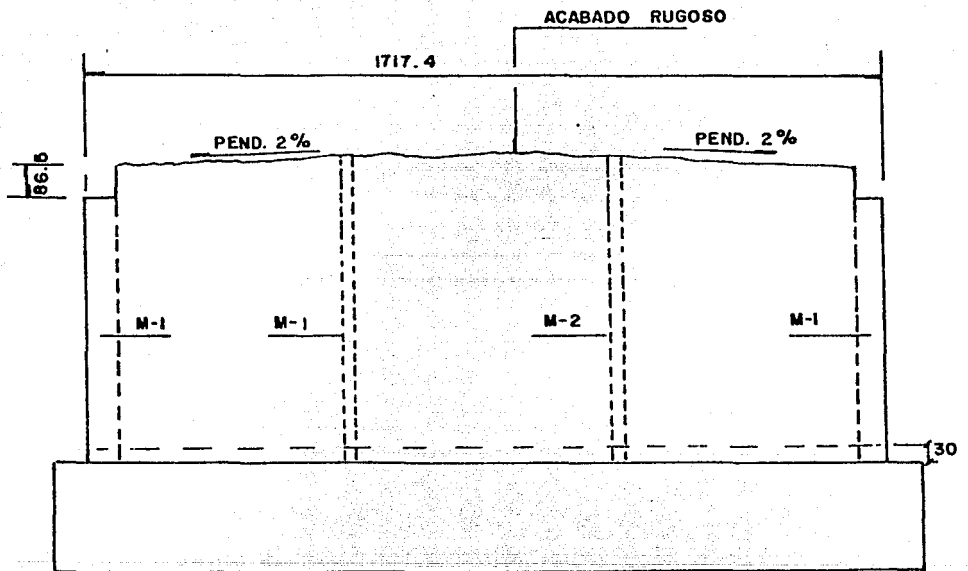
ELEVACION DE MURO TAPON NORTE Y SUR.
